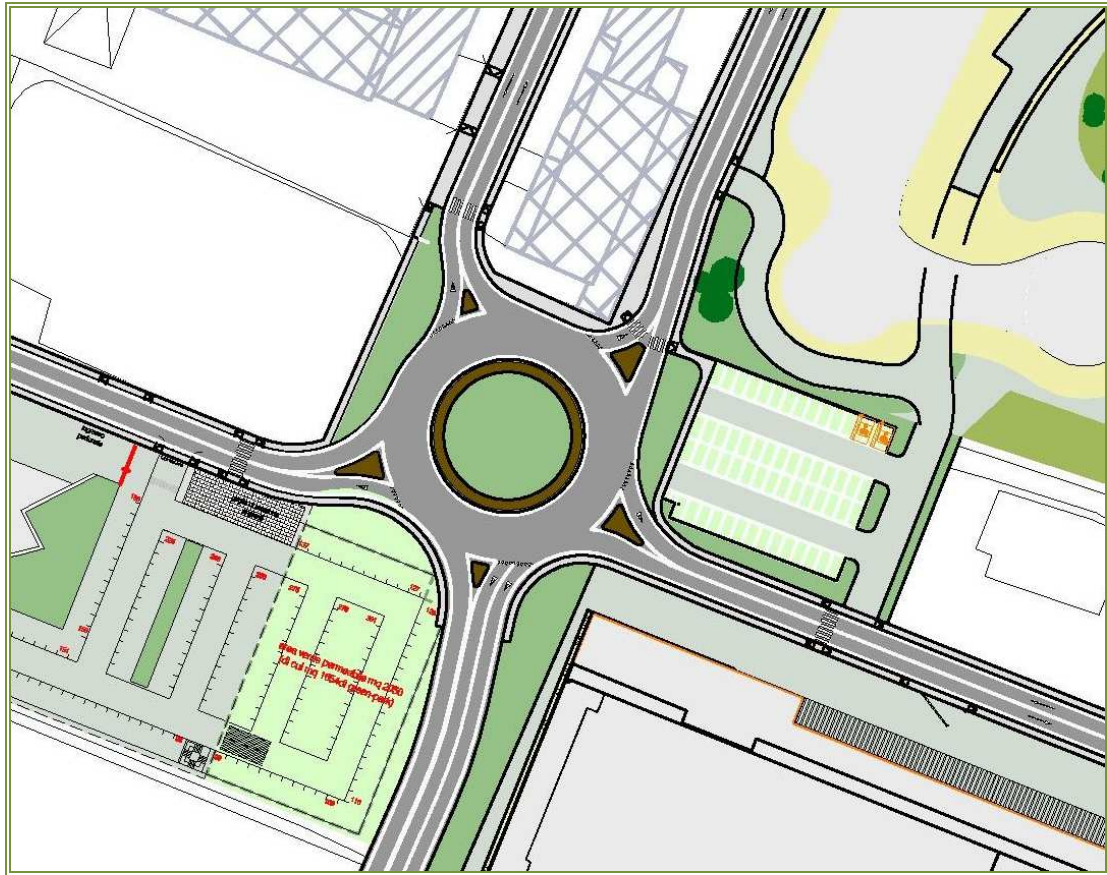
Planimetria Rotatoria Centrale Svincolo Vigasio Nord – 2° Traversa via Gioia
